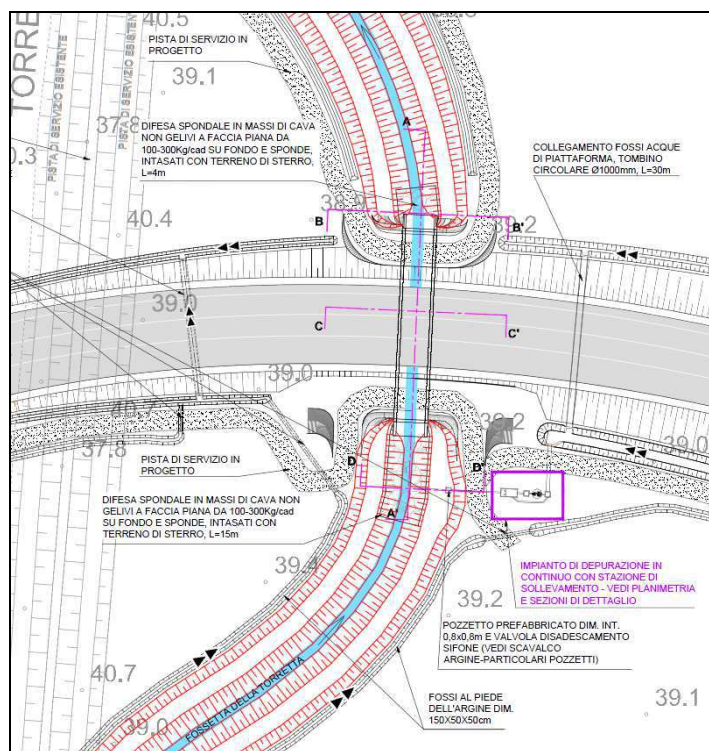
particolare planimetrico dello scricco nella Fossetta della Torretta (sponda destra)
